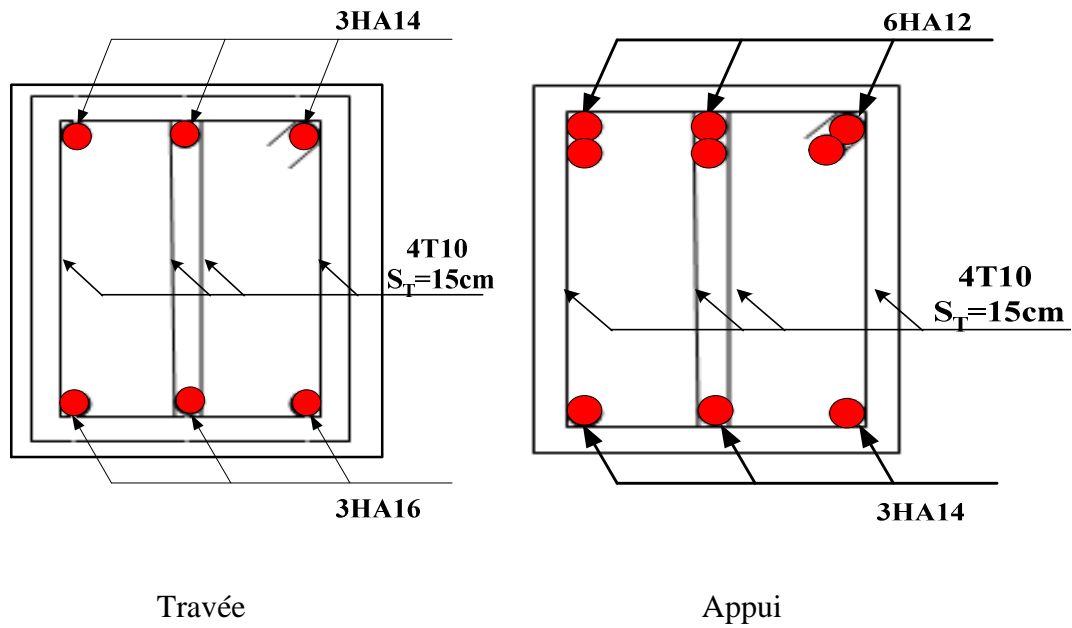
Schéma de ferrailage des poutres secondaires des entre sol, RDC et les étages courants
